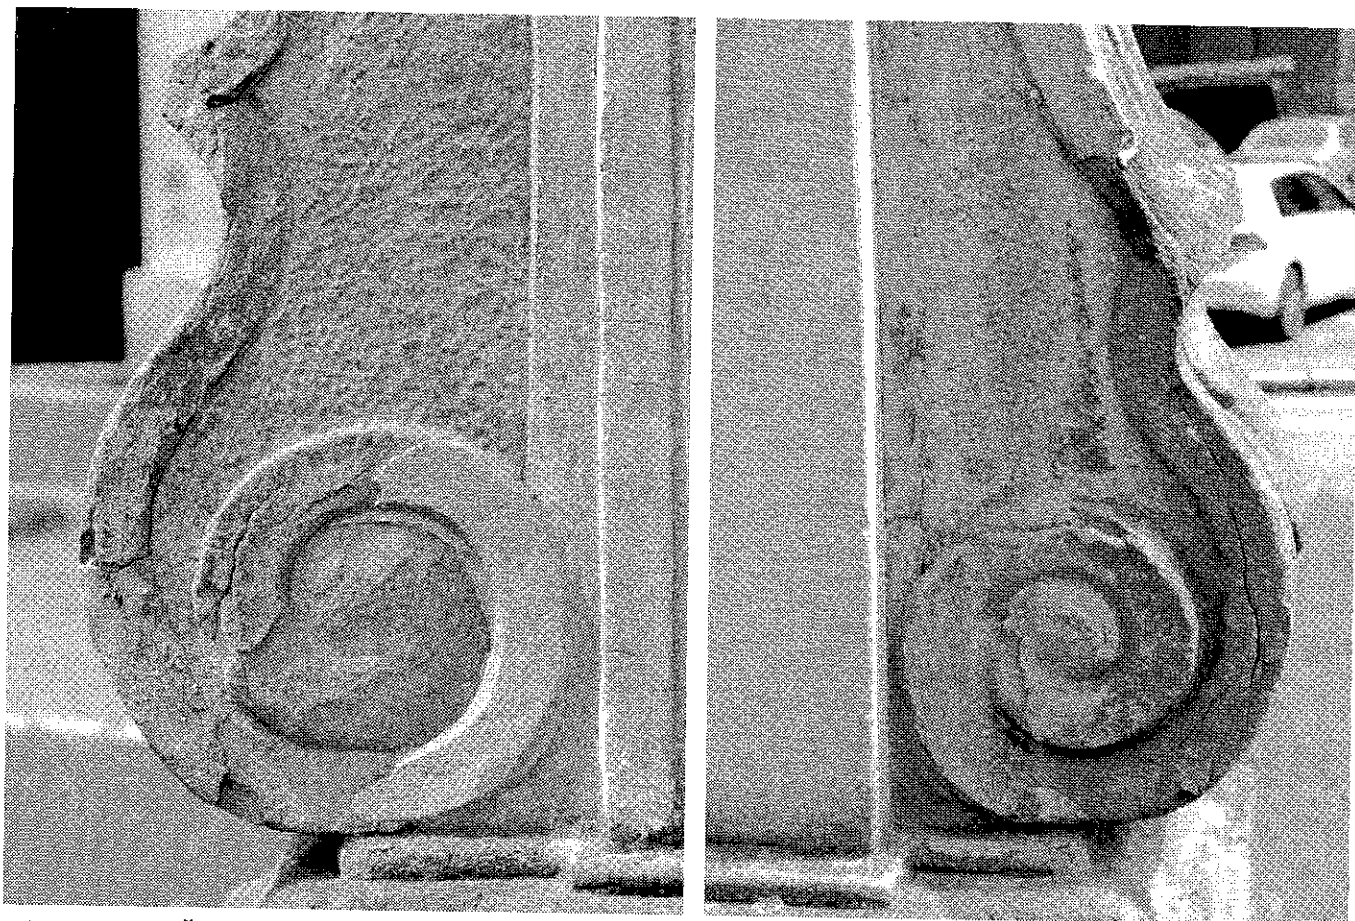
Čelní strana spodního bloku podstavce. Detail rohu s degradovaným tmelem.
